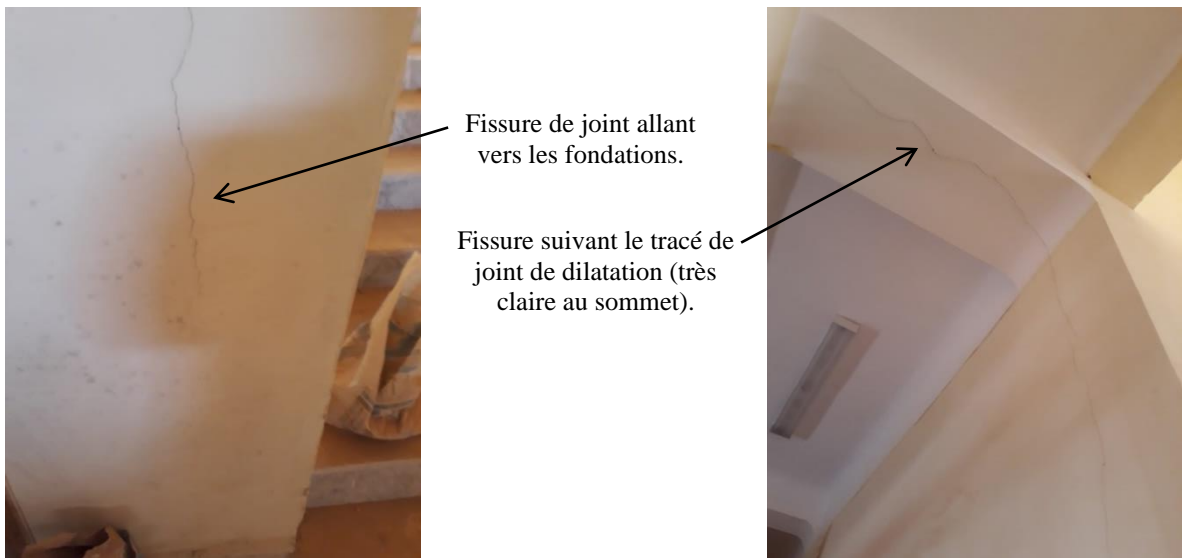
, 2.14. Le tracé de joint de dilatation fissuré
